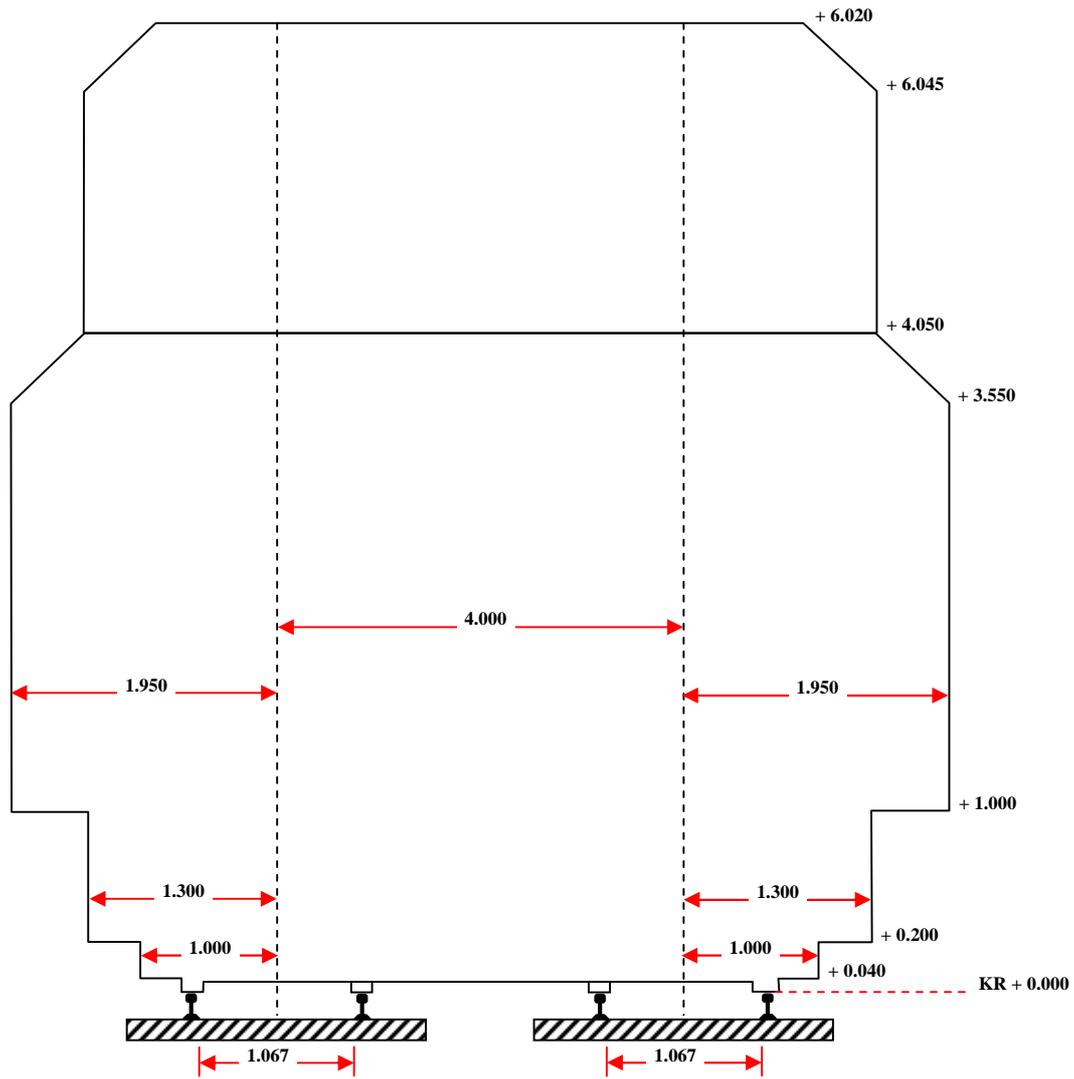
Ruang Bebas Lebar Jalan Rel 1067 mm Pada Lengkungan
